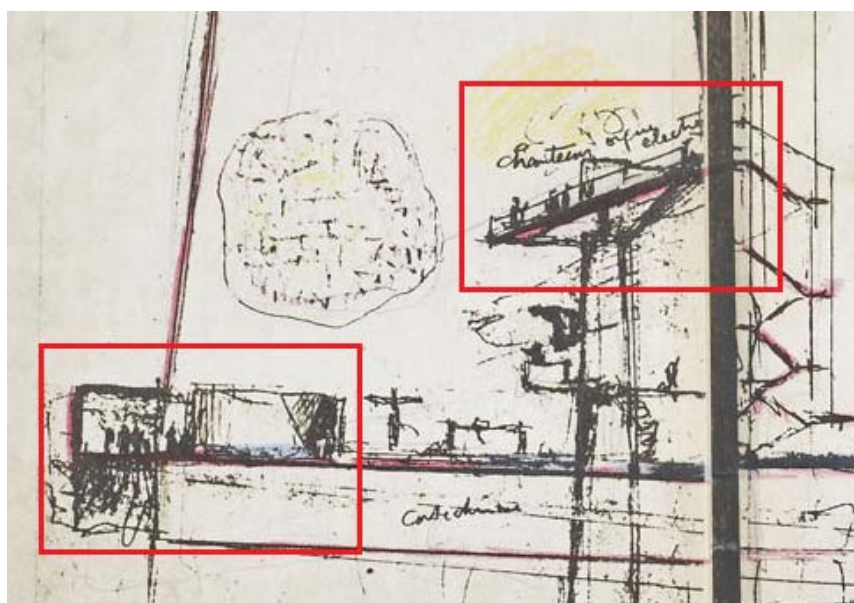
Detalle en sección de la inmensa columna, púlpito y tribuna del coro, en sección.
